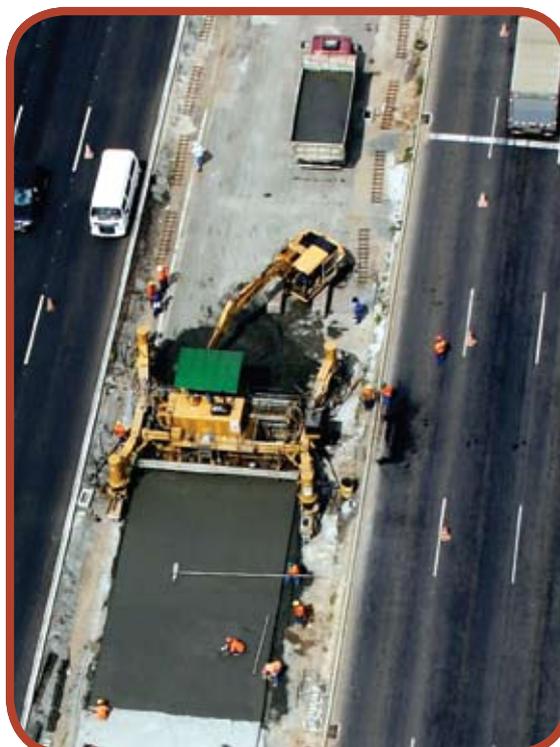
Distribuição do concreto com auxílio de escavadeira
